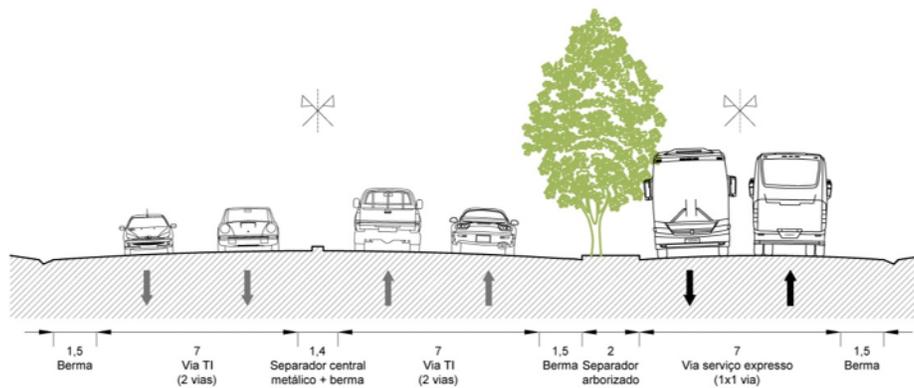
Perfil-tipo de espaço-canal com via dedicada para serviço expresso: Variante EN-249-3 e VLN (opção 2)
